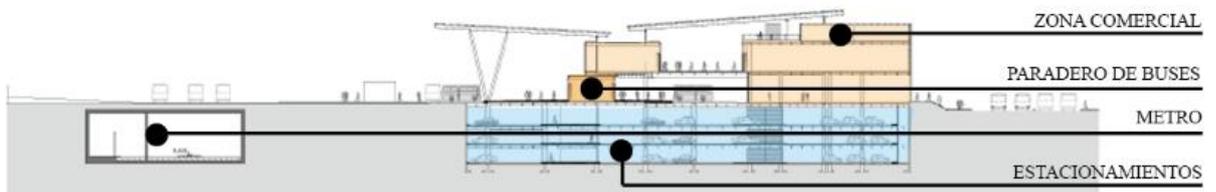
Corte transversal 4 Estación Cuatro Caminos. Fuente: Archdaily, 2018
